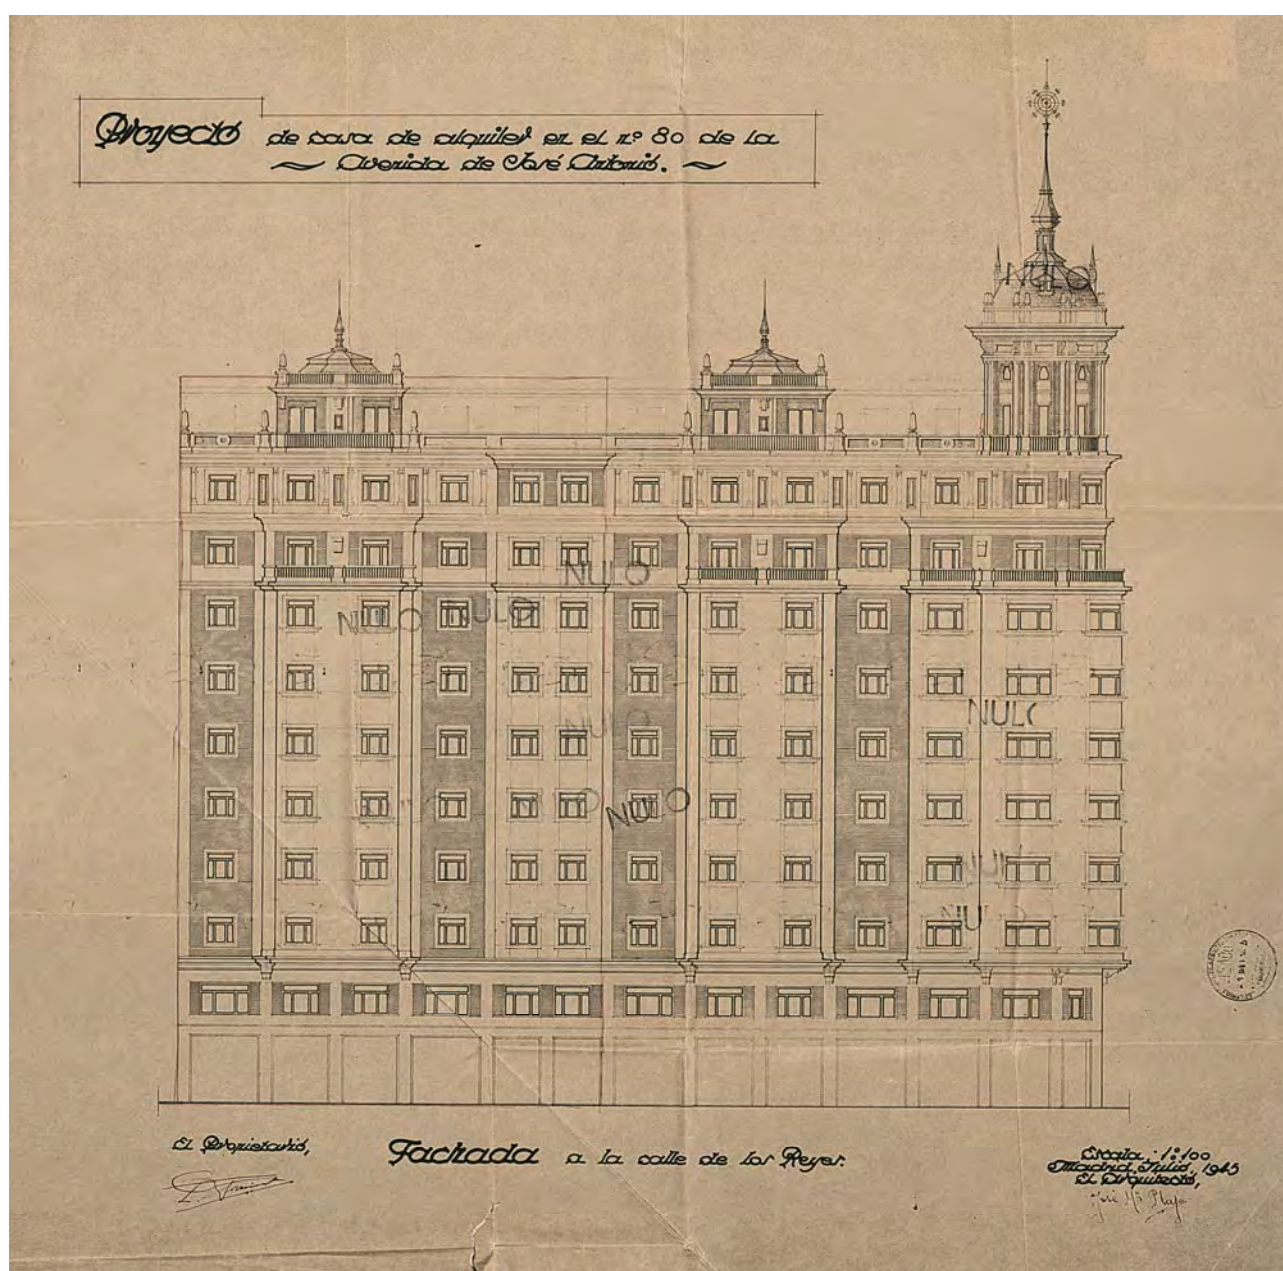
Alzado de la fachada a la calle de los Reyes del futuro hotel Astoria, septiembre de 1945. Arquitecto: José María Plaja Tobía. AVM: 43-375-15.
